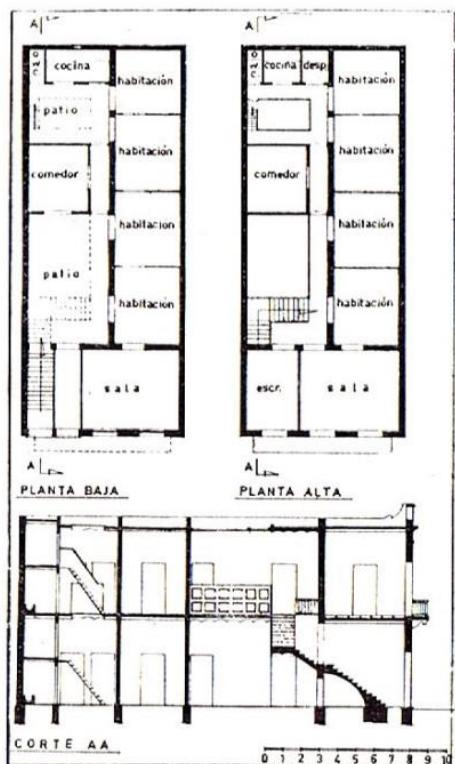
Planta y alzado de una casa estándar, 1900. Fuente: Giuria, 1958.
